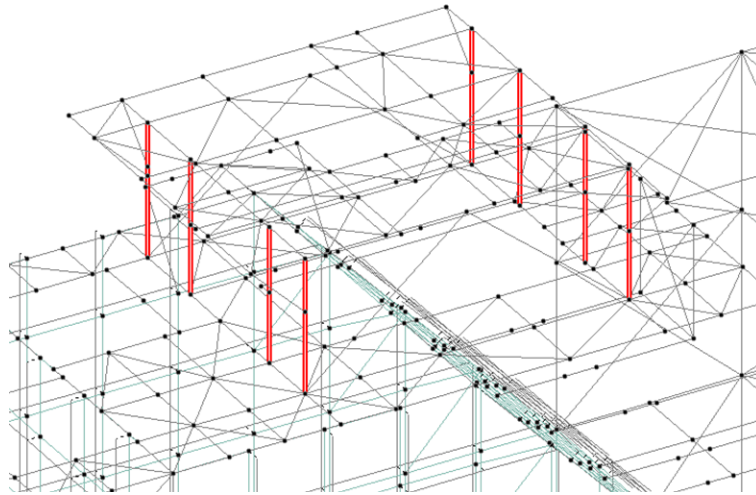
Columnas modificadas a sección HN20x 69.4
